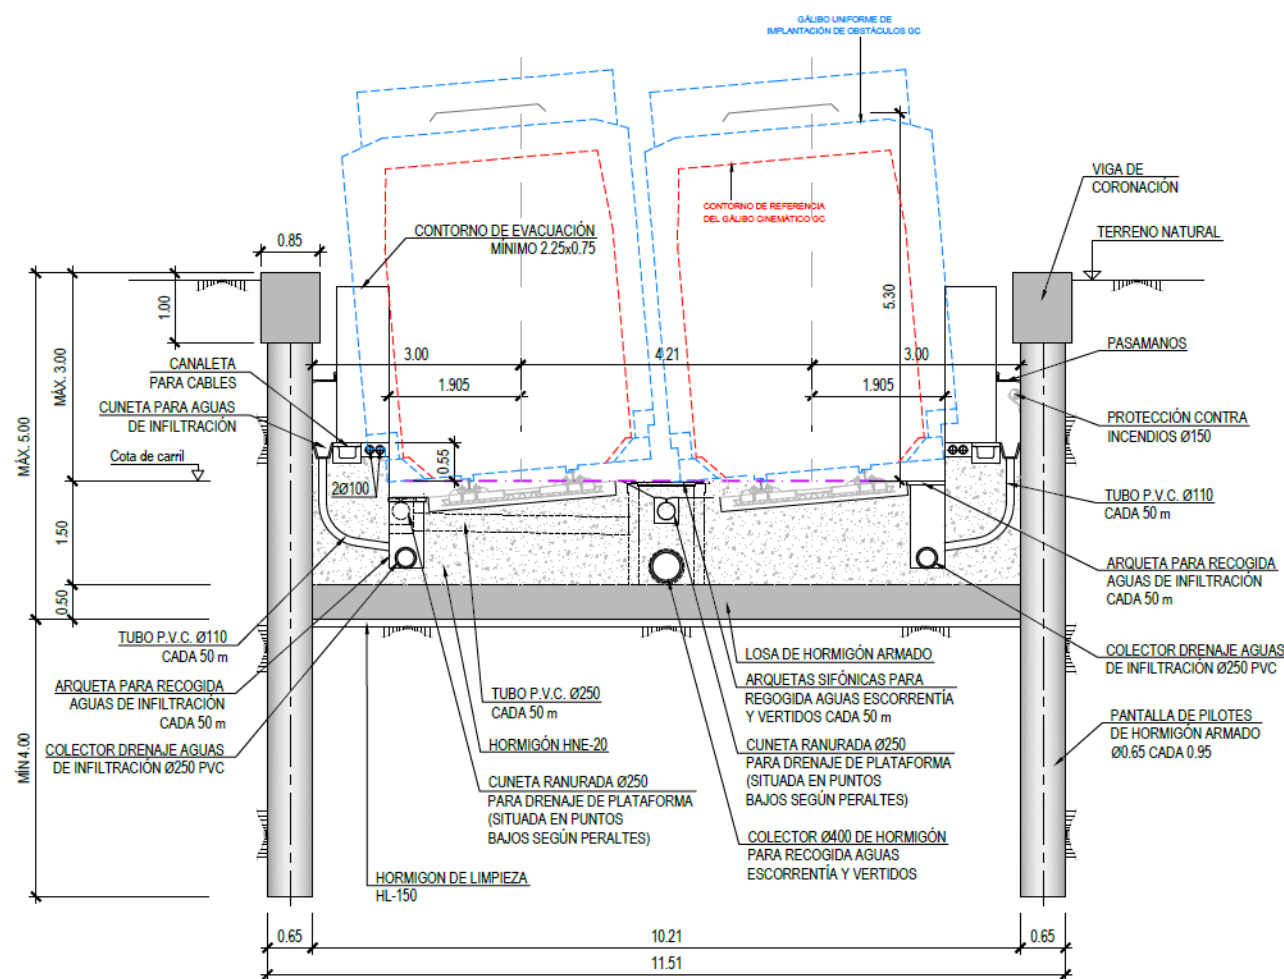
a.- Sección tipo 1 en rampas (ST-R1).
